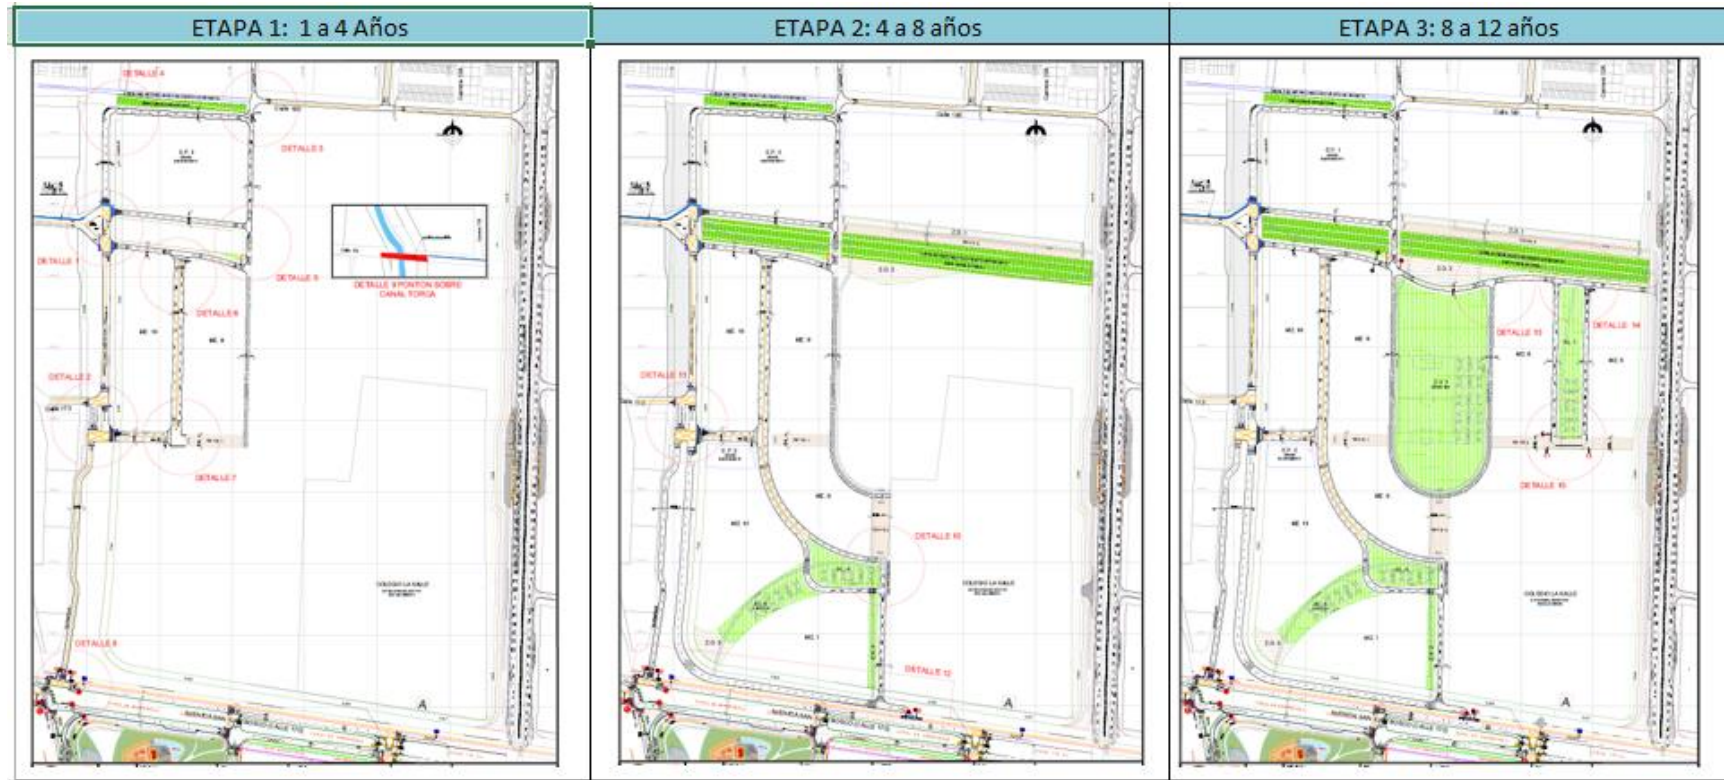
Detalles de las obras viales correspondientes a las etapas 1, 2 y 3 de desarrollo del plan parcial
